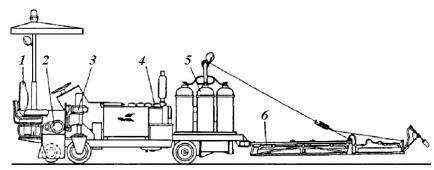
Машины для разогрева и фрезерования асфальтобетонных покрытий при ремонте: 1 – место оператора; 2 – привод и фреза для отделения разогретого асфальтобетона; 3 – ходовое устройство; 4 – двигатель; 5 – резервуары для газообразного топлива; 6 – нагревательная система
